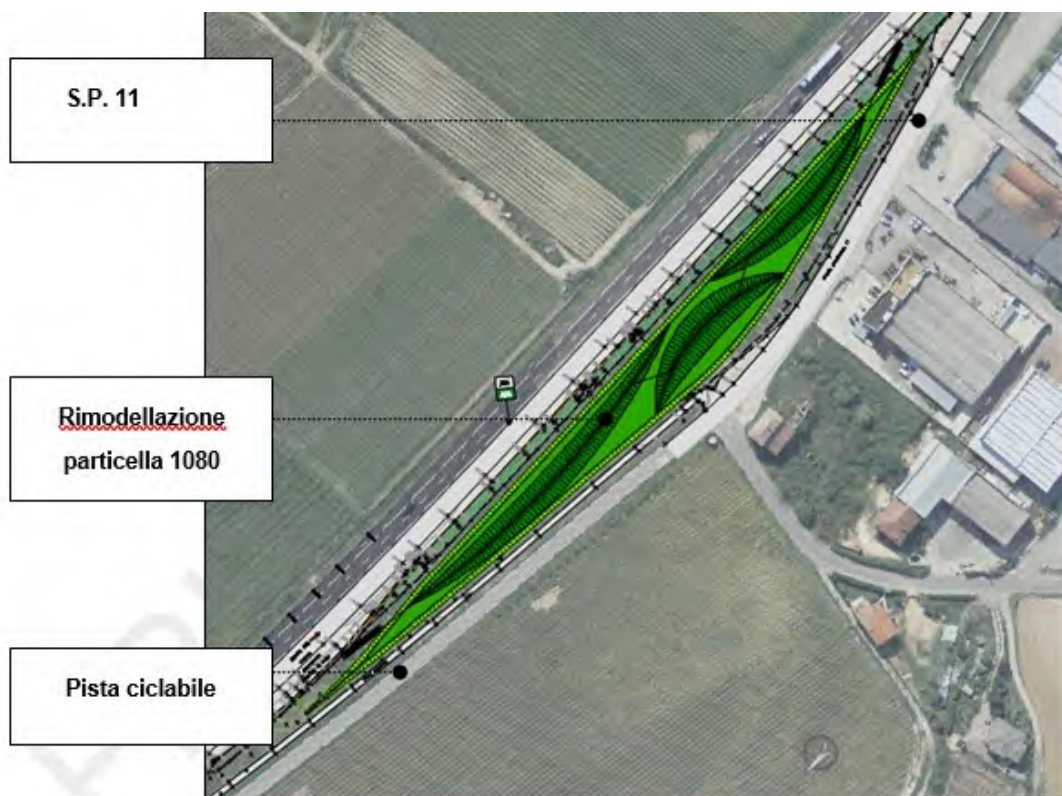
Estratto planimetrico con localizzazione dell'intervento (stralcio tavole INTERVENTI DI RIMODELLAZIONE CON SISTEMAZIONE AMBIENTALE, allegate al progetto)
